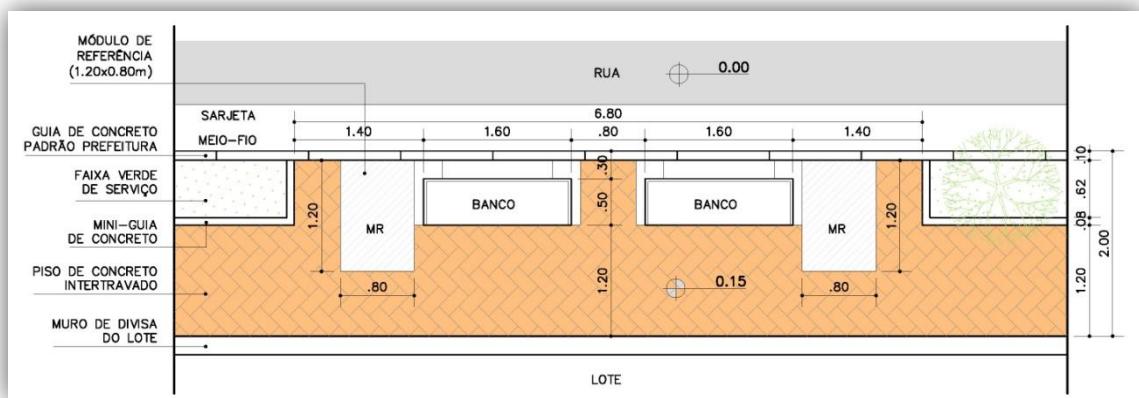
Planta do detalhe tipo 16 A2: Bancos públicos (calçada largura de 2,00m); sem escala.
